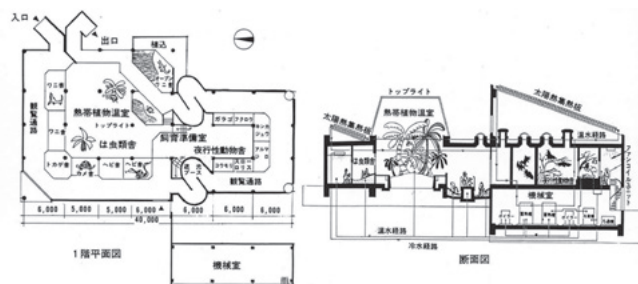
平面図 図5 断面図(本誌1980年12月号掲載)
